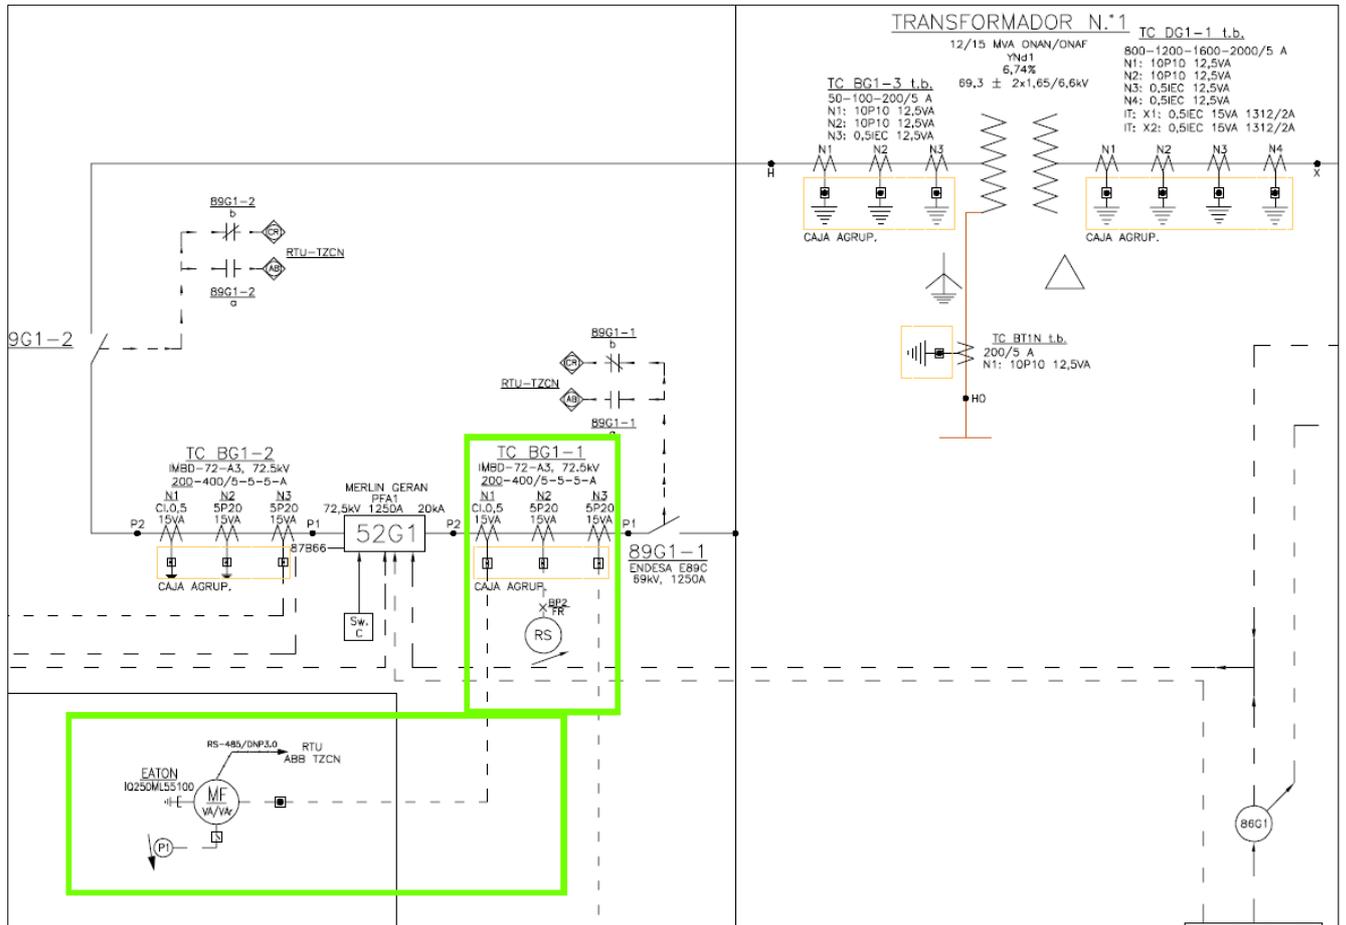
Unilineal de planta esquemático – Salida de Barra 66 kV (LQ1)
